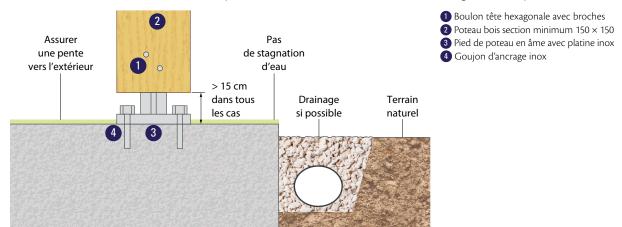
Exemple de fixation au sol du pied de poteau de l'auvent
